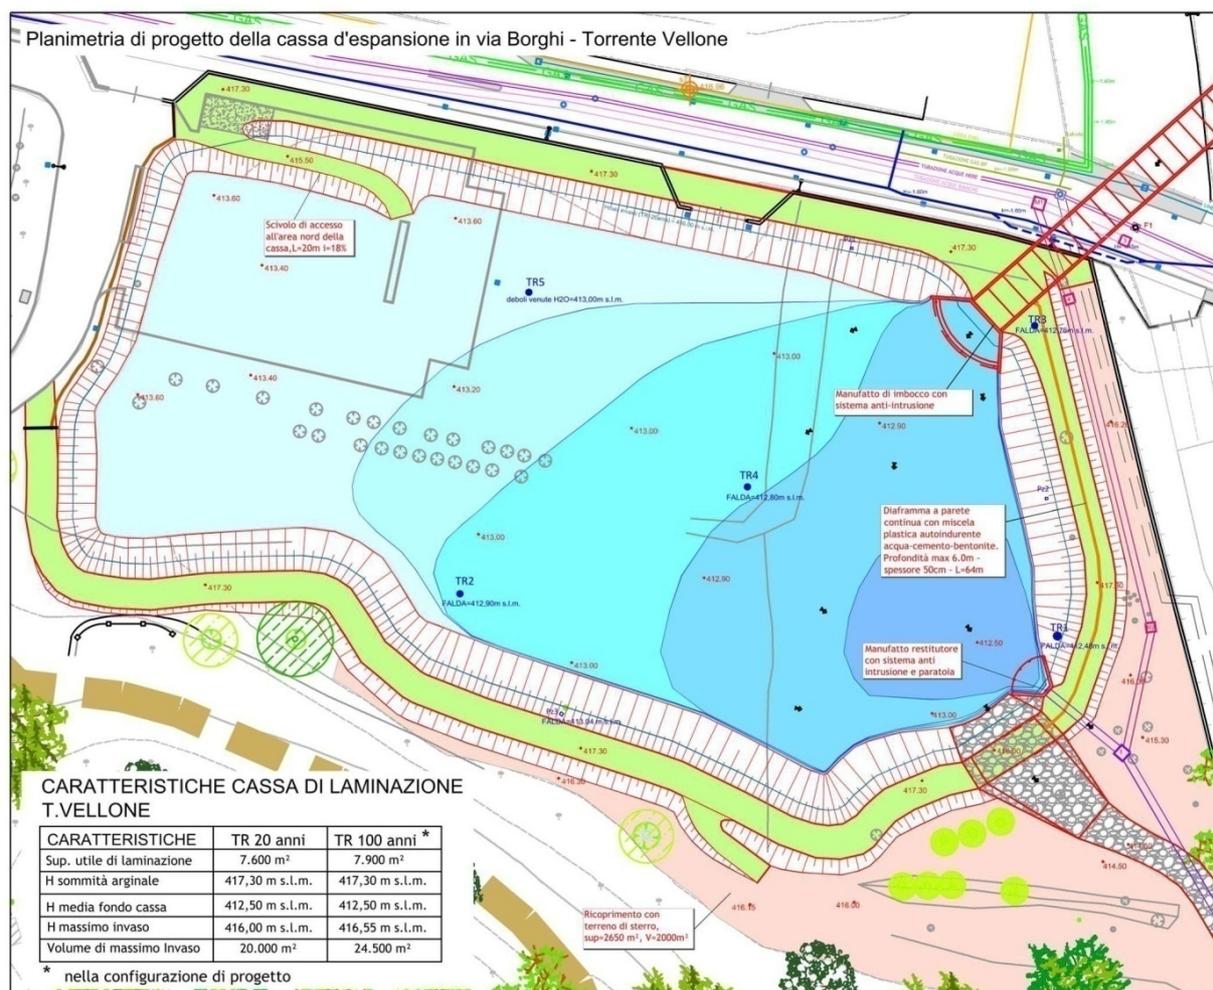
Planimetria di progetto vasca di laminazione via Giovanni Borghi.
